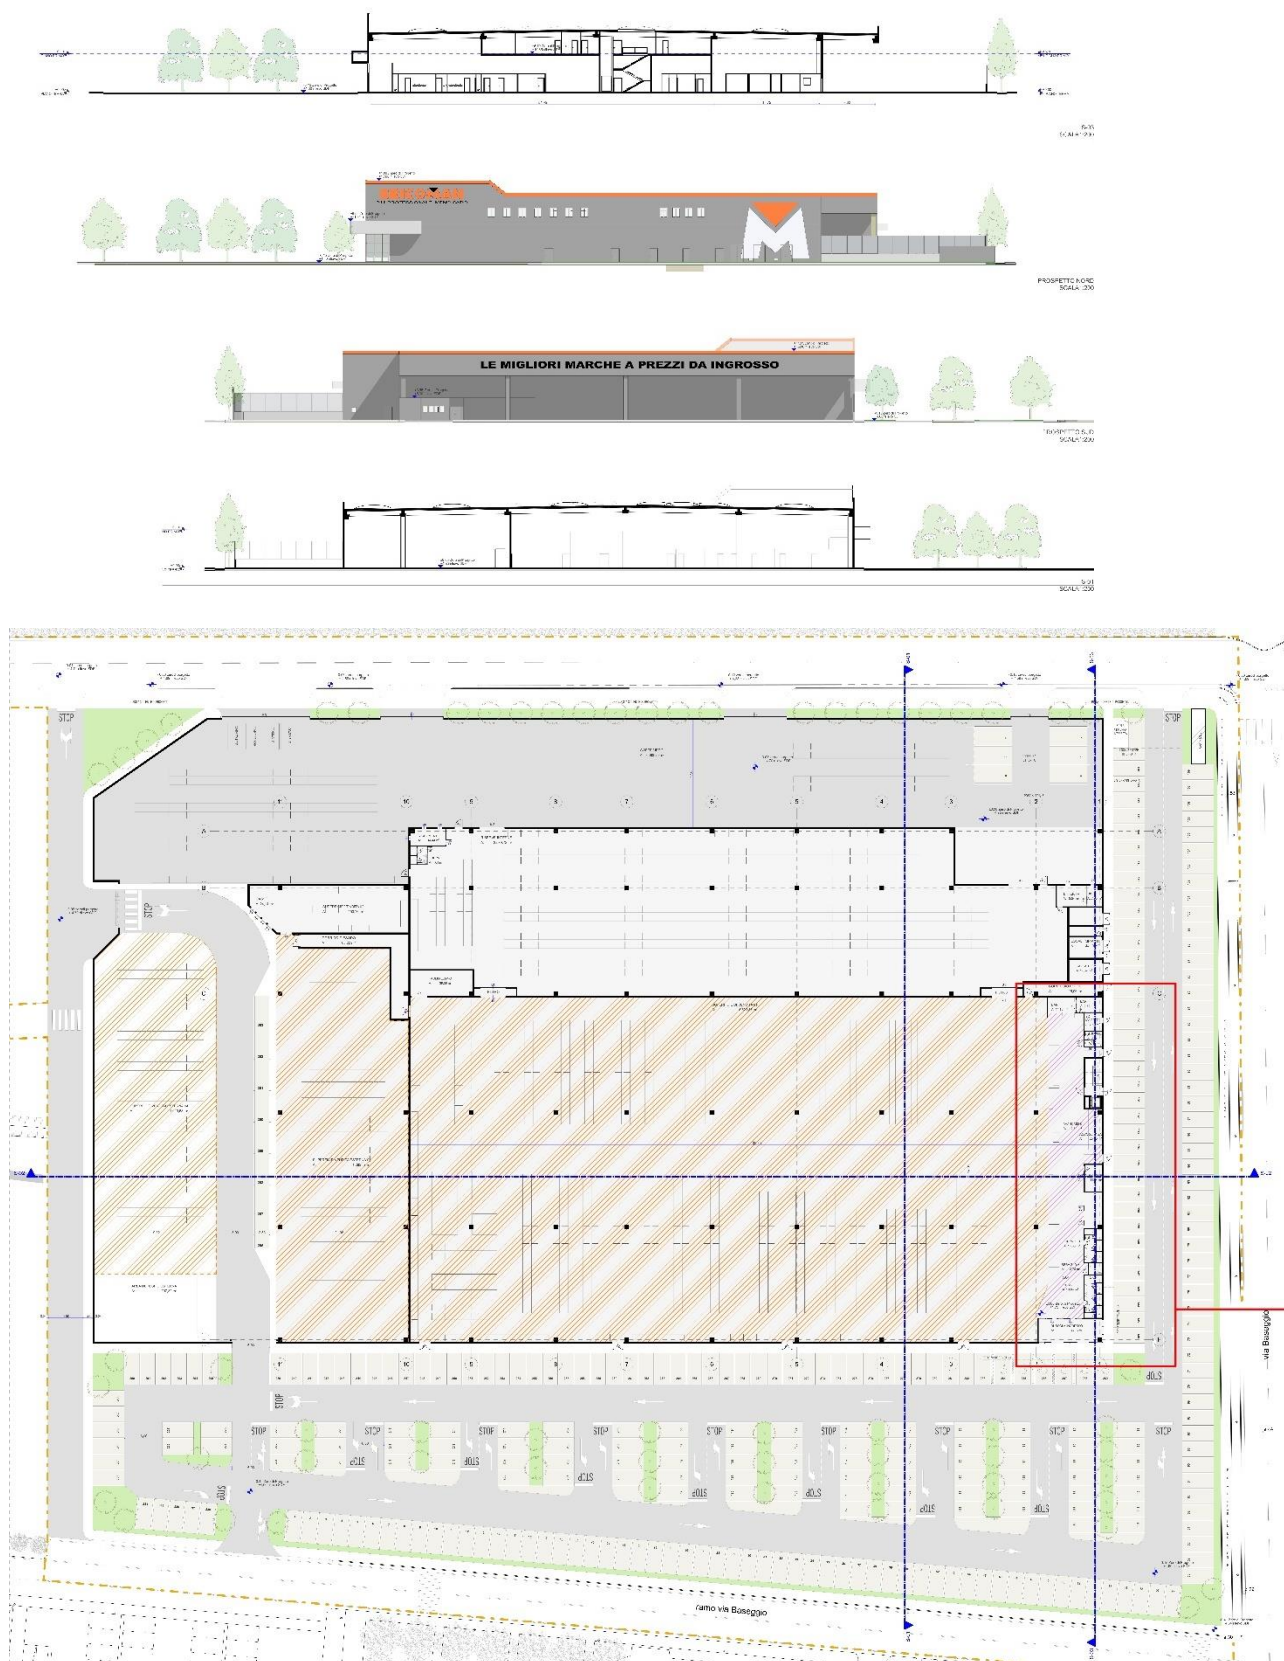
Sezioni, prospetti e rappresentazione planimetrica del fabbricato di progetto (Fonte: Stato di progetto – Pianta piano terra e piano primo e verifiche standards urbanistici– AI Progetti)
